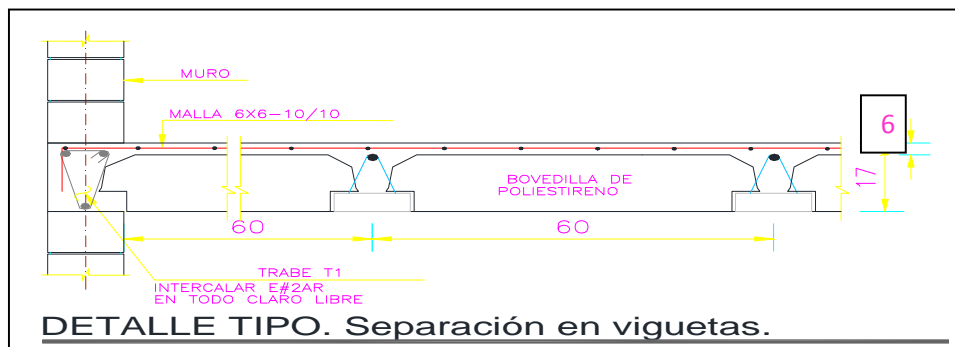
Detalle tipo de losas de entresijos y azoteas
